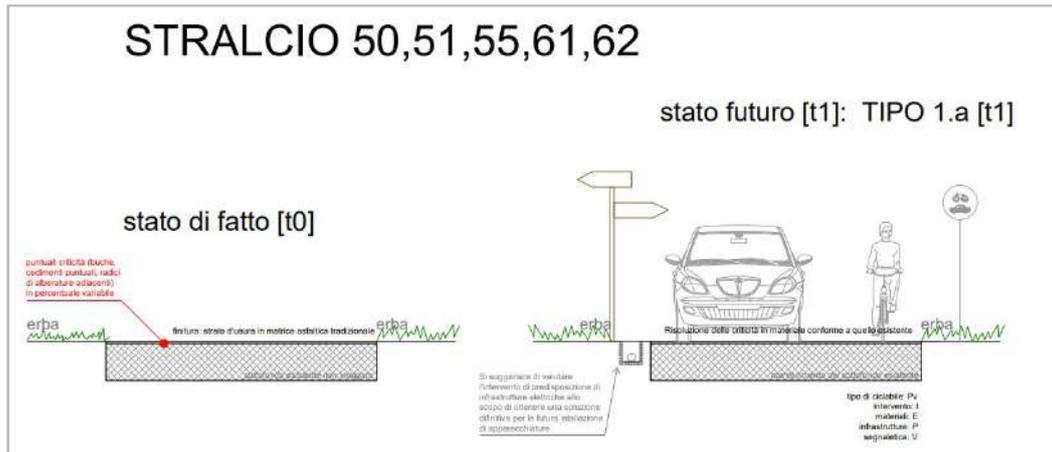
Stato attuale - Stato futuro e fondo di progetto di tipo 1.a
